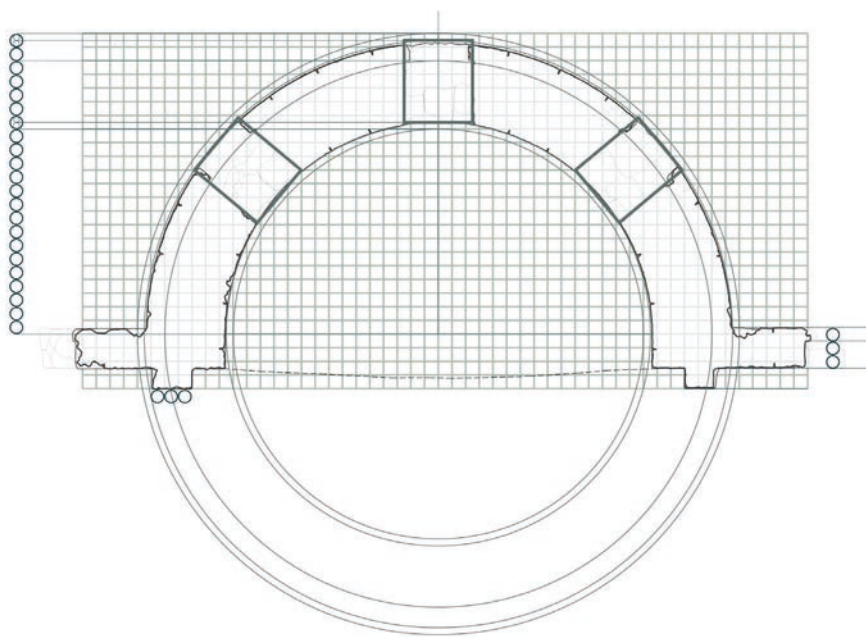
Studio geometrico in pianta su griglia di modulo 30,8 cm (piede attico) (@AskGate).
